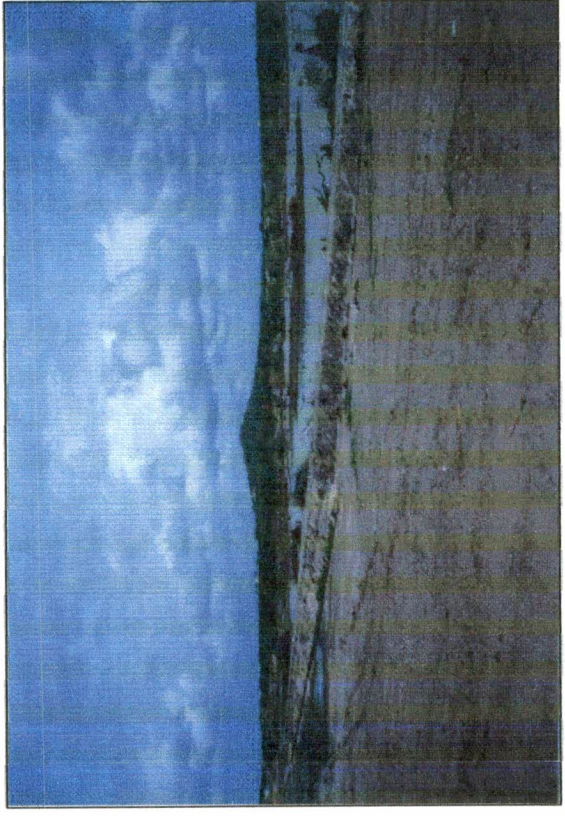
Pequeno açude construído para utilização na obra (ensecadeira).
